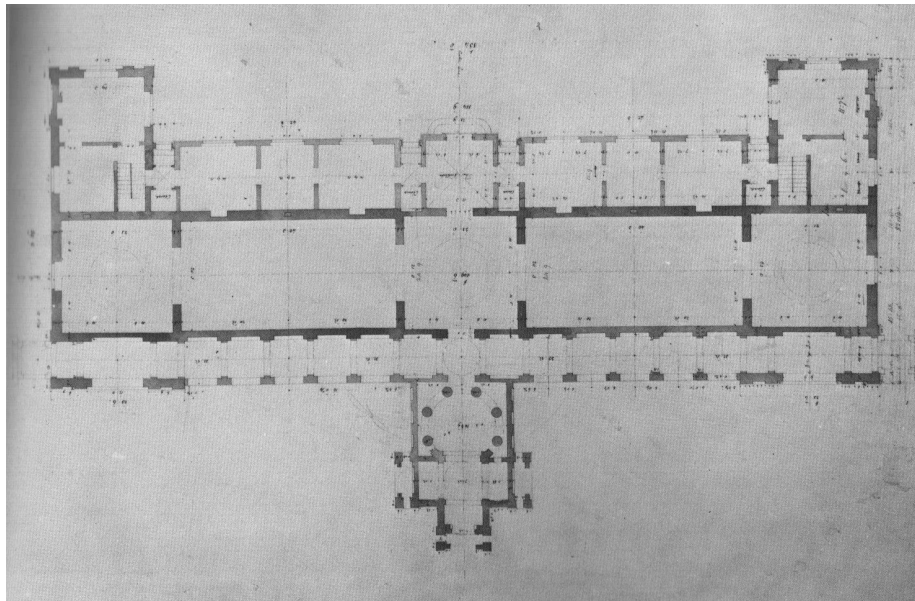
Planta de la Dulwich Gallery de John Soane en Londres
